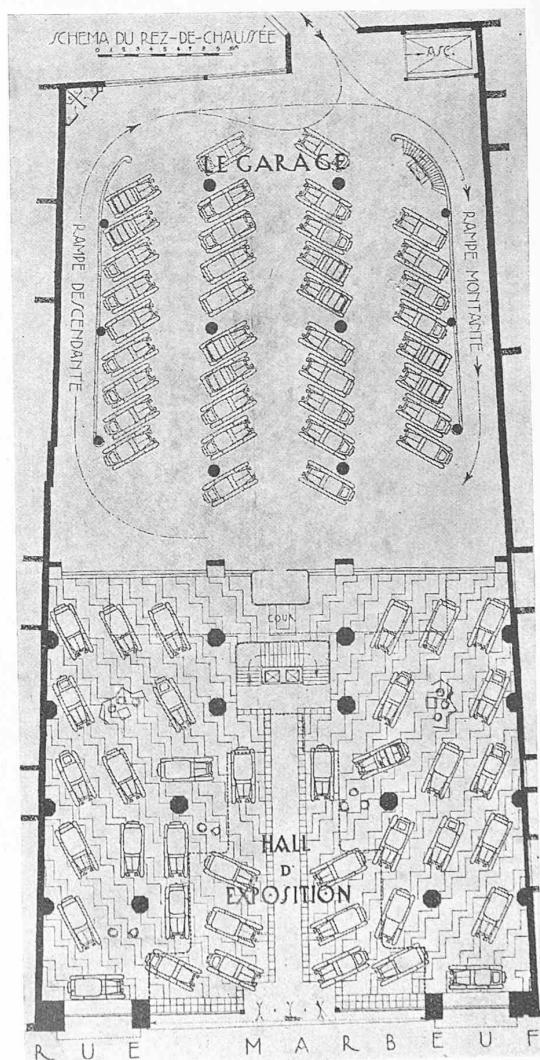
Grundriss vom Erdgeschoss. — Masstab 1 : 500.
